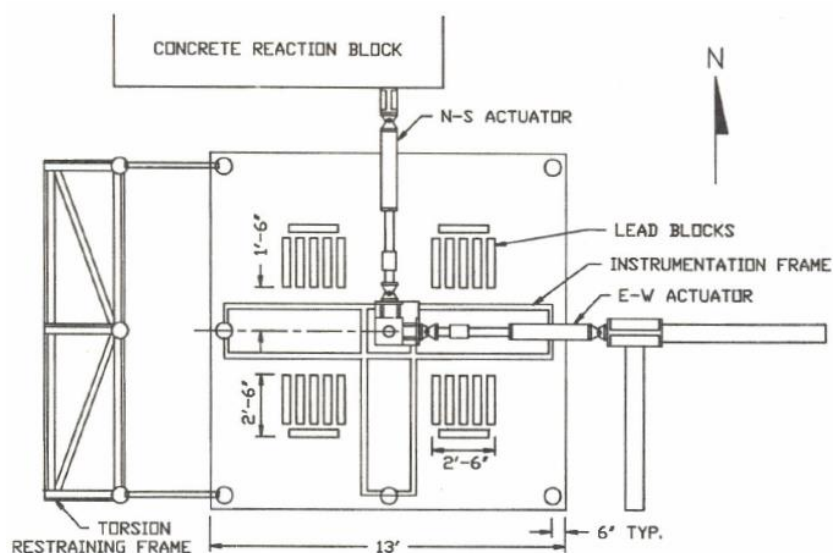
Vista em planta do sistema de ensaio utilizado por Pan e Moehle [37]
